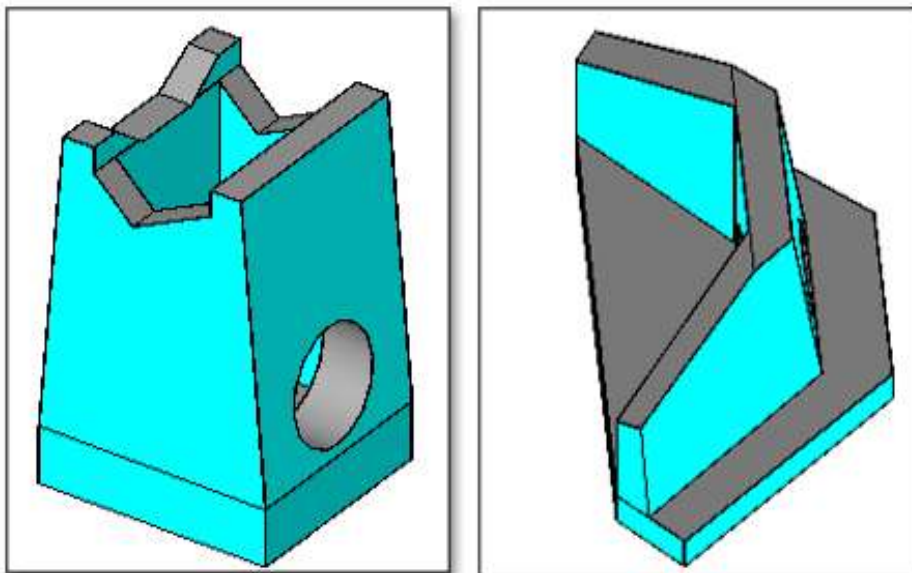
Modelado de encofrado de los componentes de las alcantarillas
